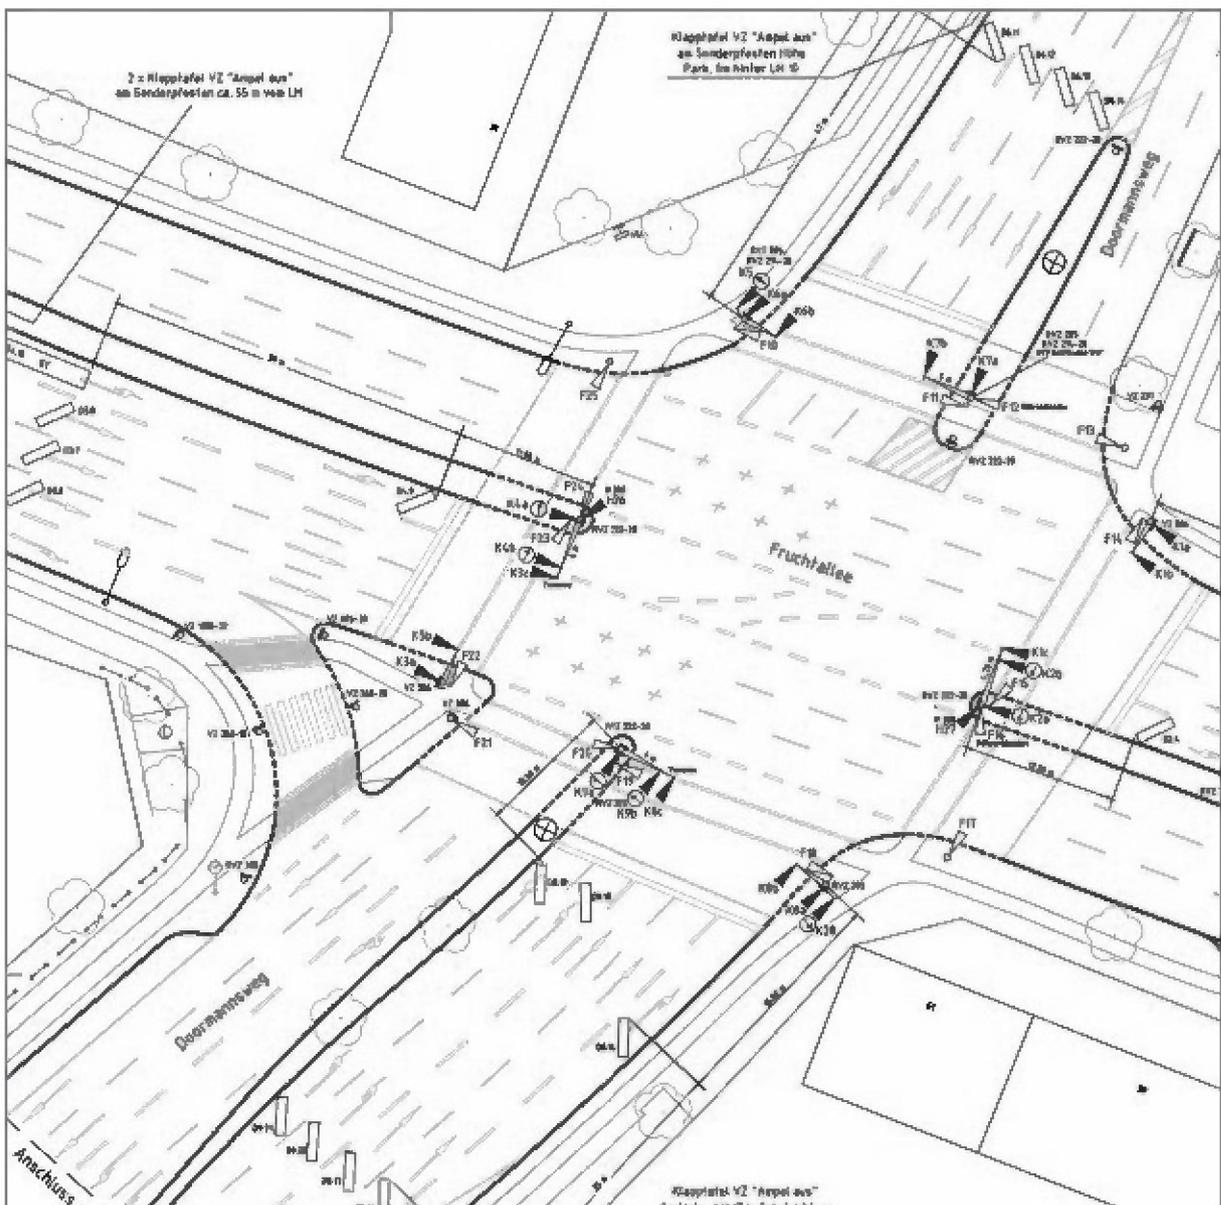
3 Signallageplanausschnitt LSA 813
